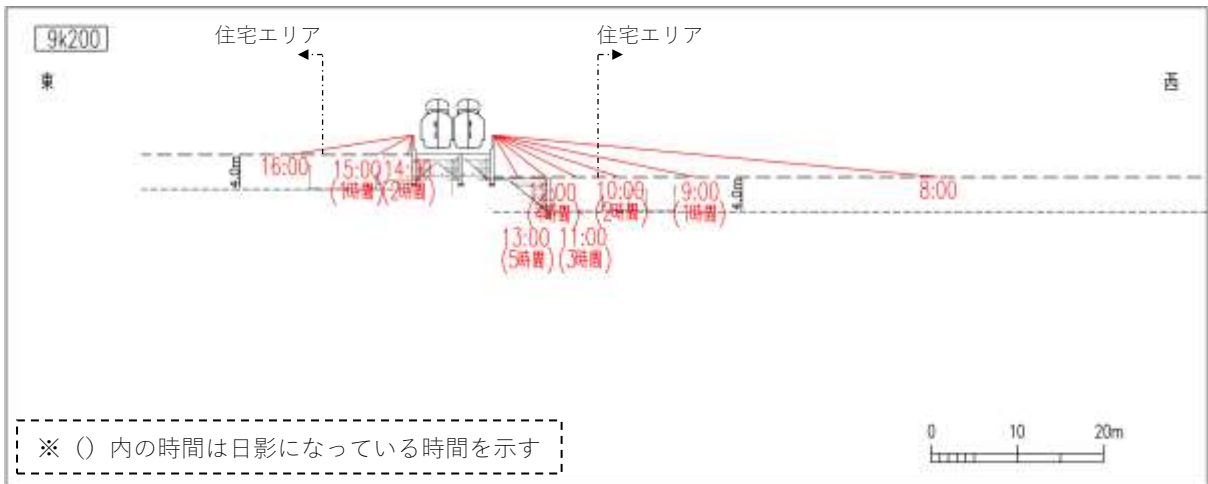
(1) 日影横断面図 (代表断面)
